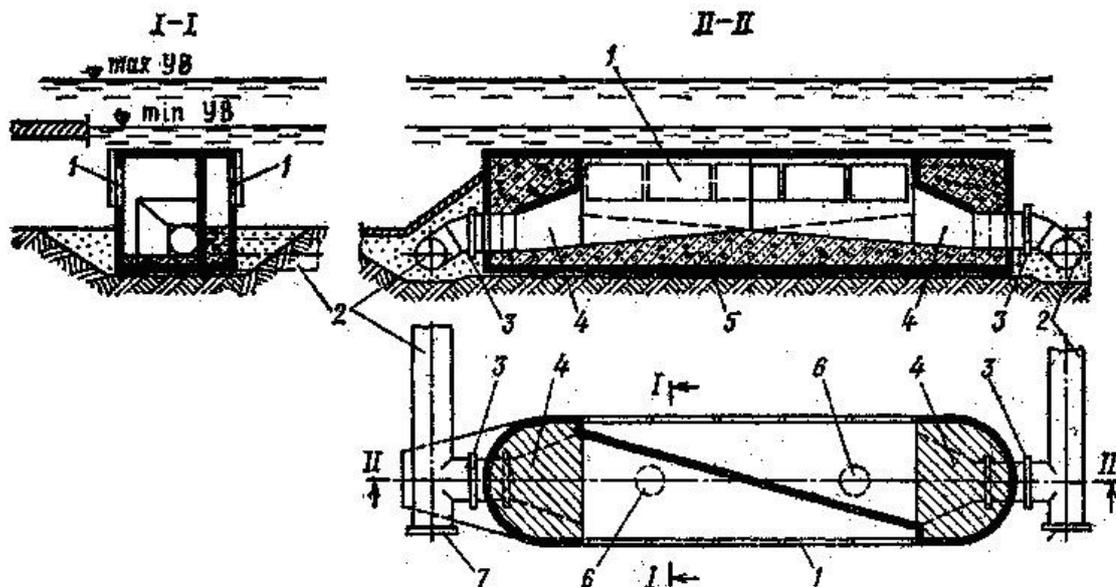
Схема железобетонного двухсекционного защищенного оголовка конструкции ВНИИВодгео:
